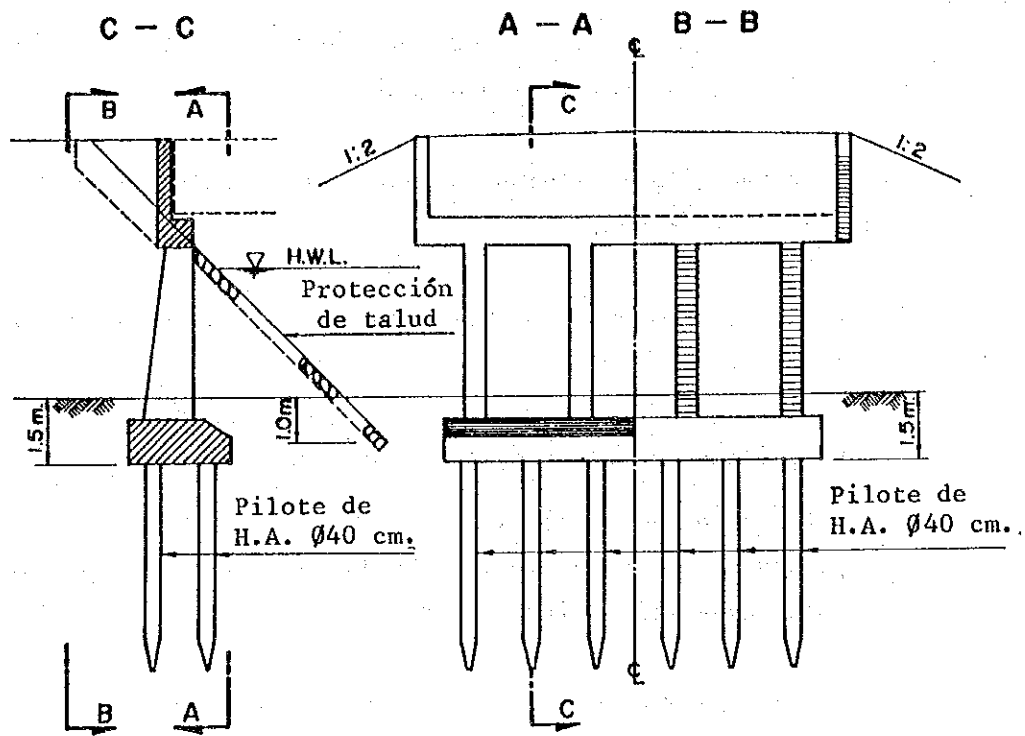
ESTRIBO TIPO RIPRAP
